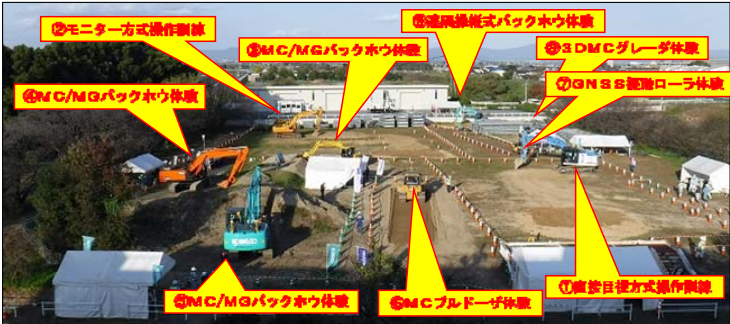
平成29年度無人化施工訓練状況例(久留米会場)
